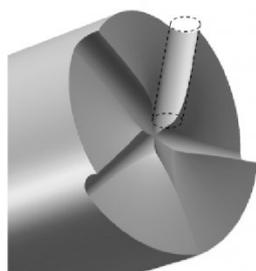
Развертка цилиндрического сечения забоя с уступами, формируемыми барабанным ИО
